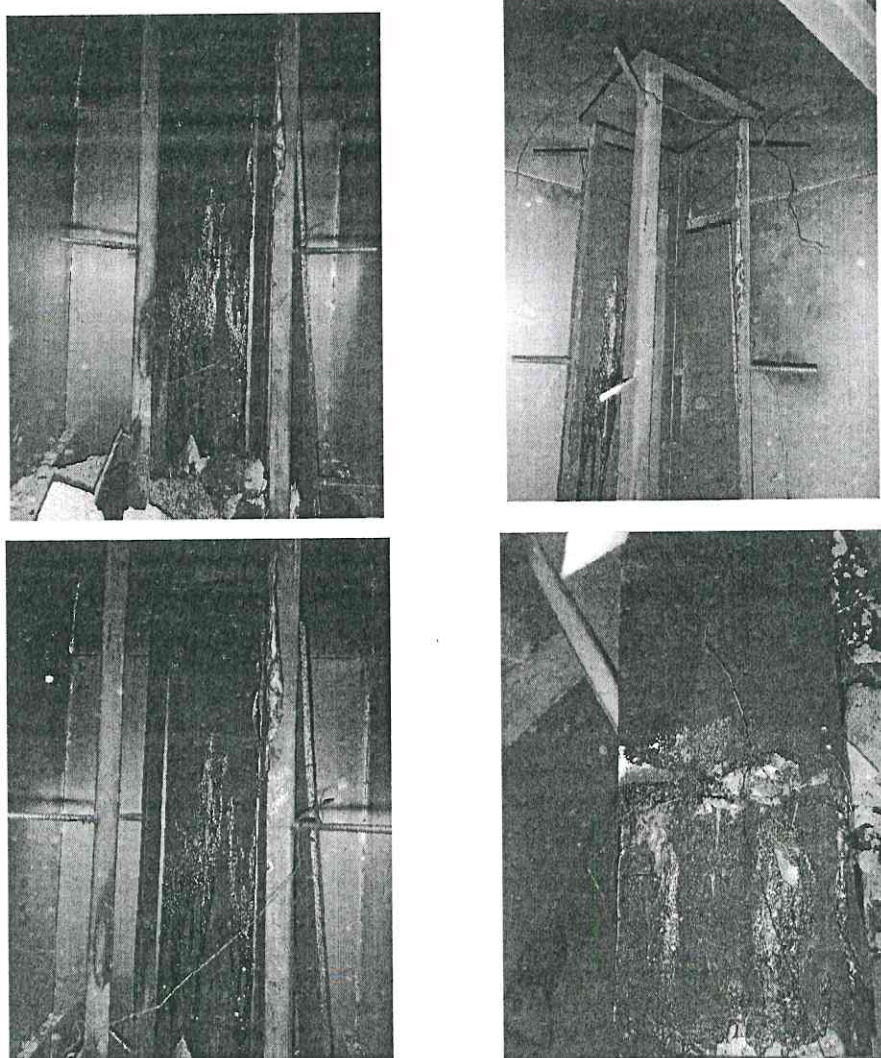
Фото образца № 05-02-2025-002 после испытаний
